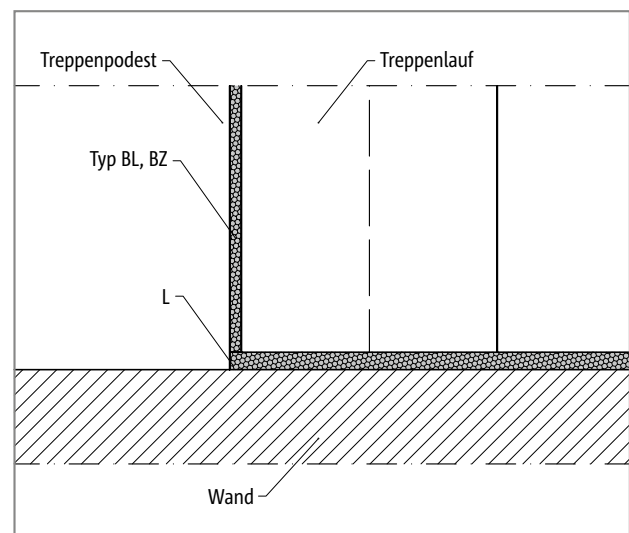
Schöck Tronsole® Typ BL, BZ: Elementanordnung, Detail B
